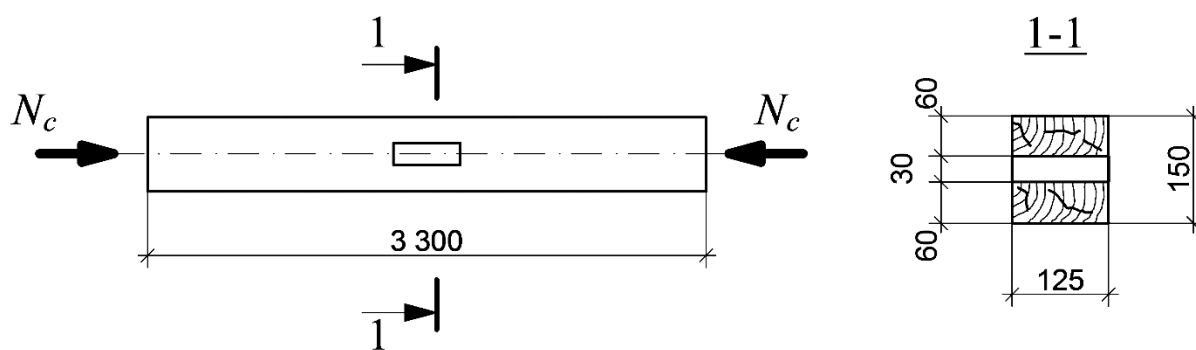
К определению расчётной площади поперечного сечения сжатого стержня
